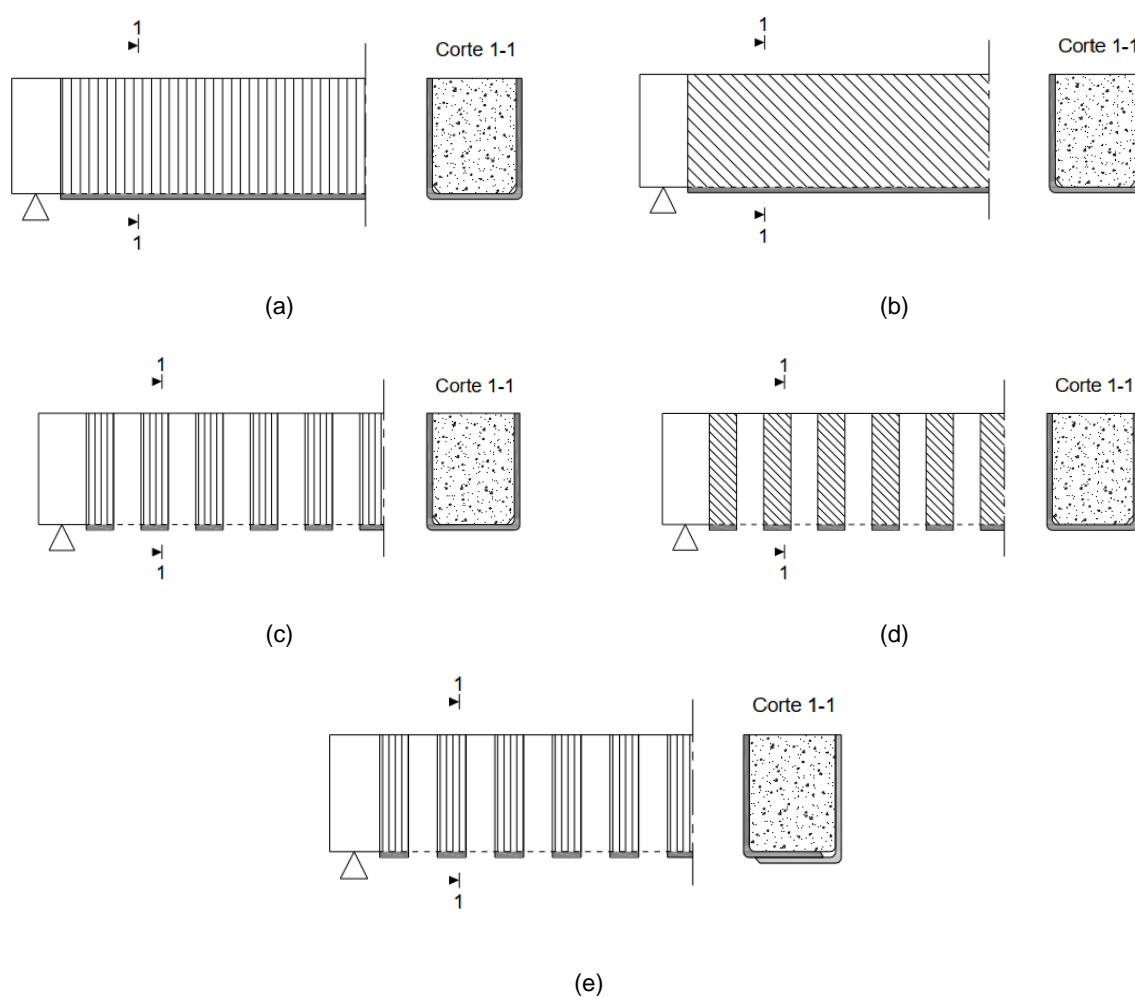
Reforço de vigas ao esforço transversal por colagem de armaduras de FRP com estribo contínuo em "U" (a) e (b), com estribo descontinuo em "U" (c) e (d) e estribo pré-fabricado em "L" com orientação das fibras de 90° (e) – adaptado de Sousa (2008)
